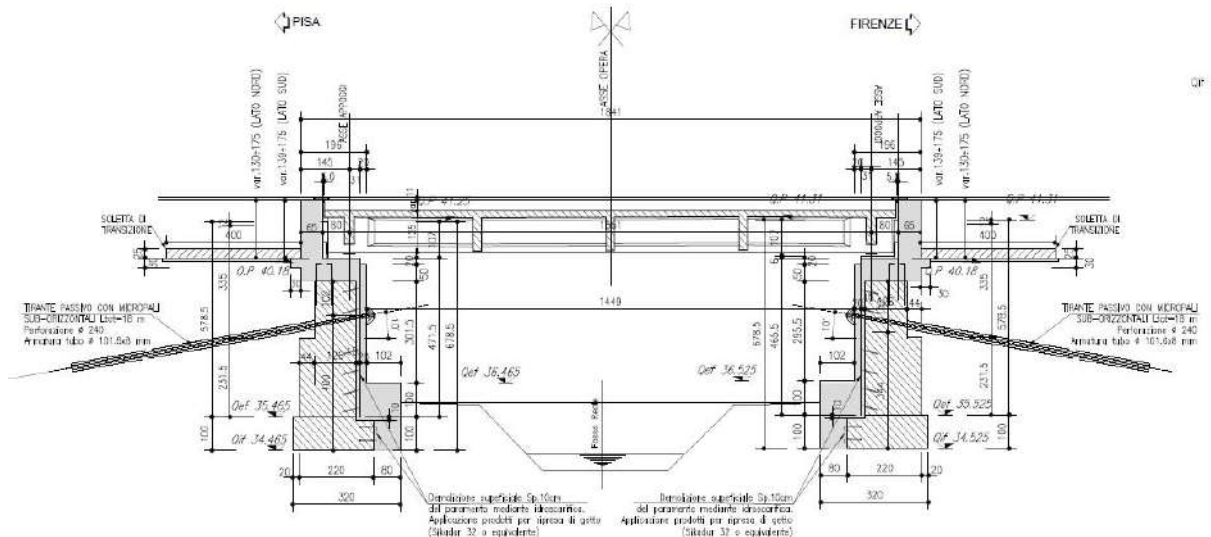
Ponte sul F. Reale. Sezione longitudinale.
